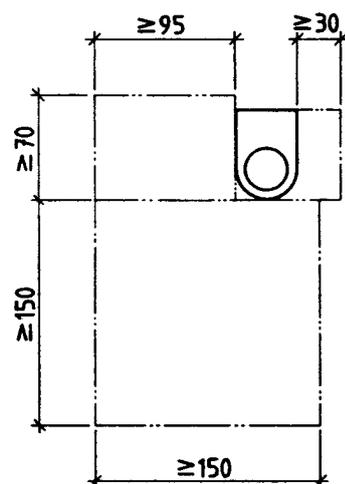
Bewegungsfläche vor und neben dem Klosettbecken
